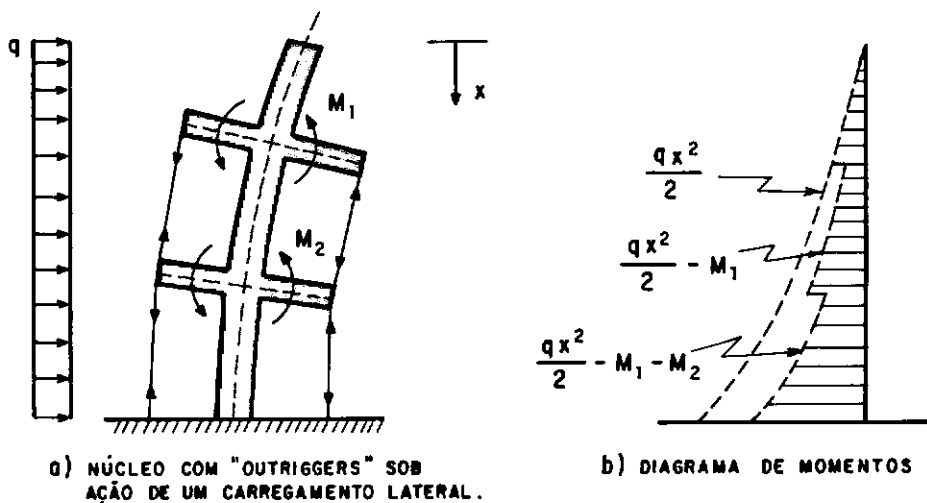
COMPORTAMENTO DE UM NÚCLEO OU PILAR-PAREDE COM "OUTRIGGERS" SOB AÇÃO DE UM CARREGAMENTO LATERAL.
